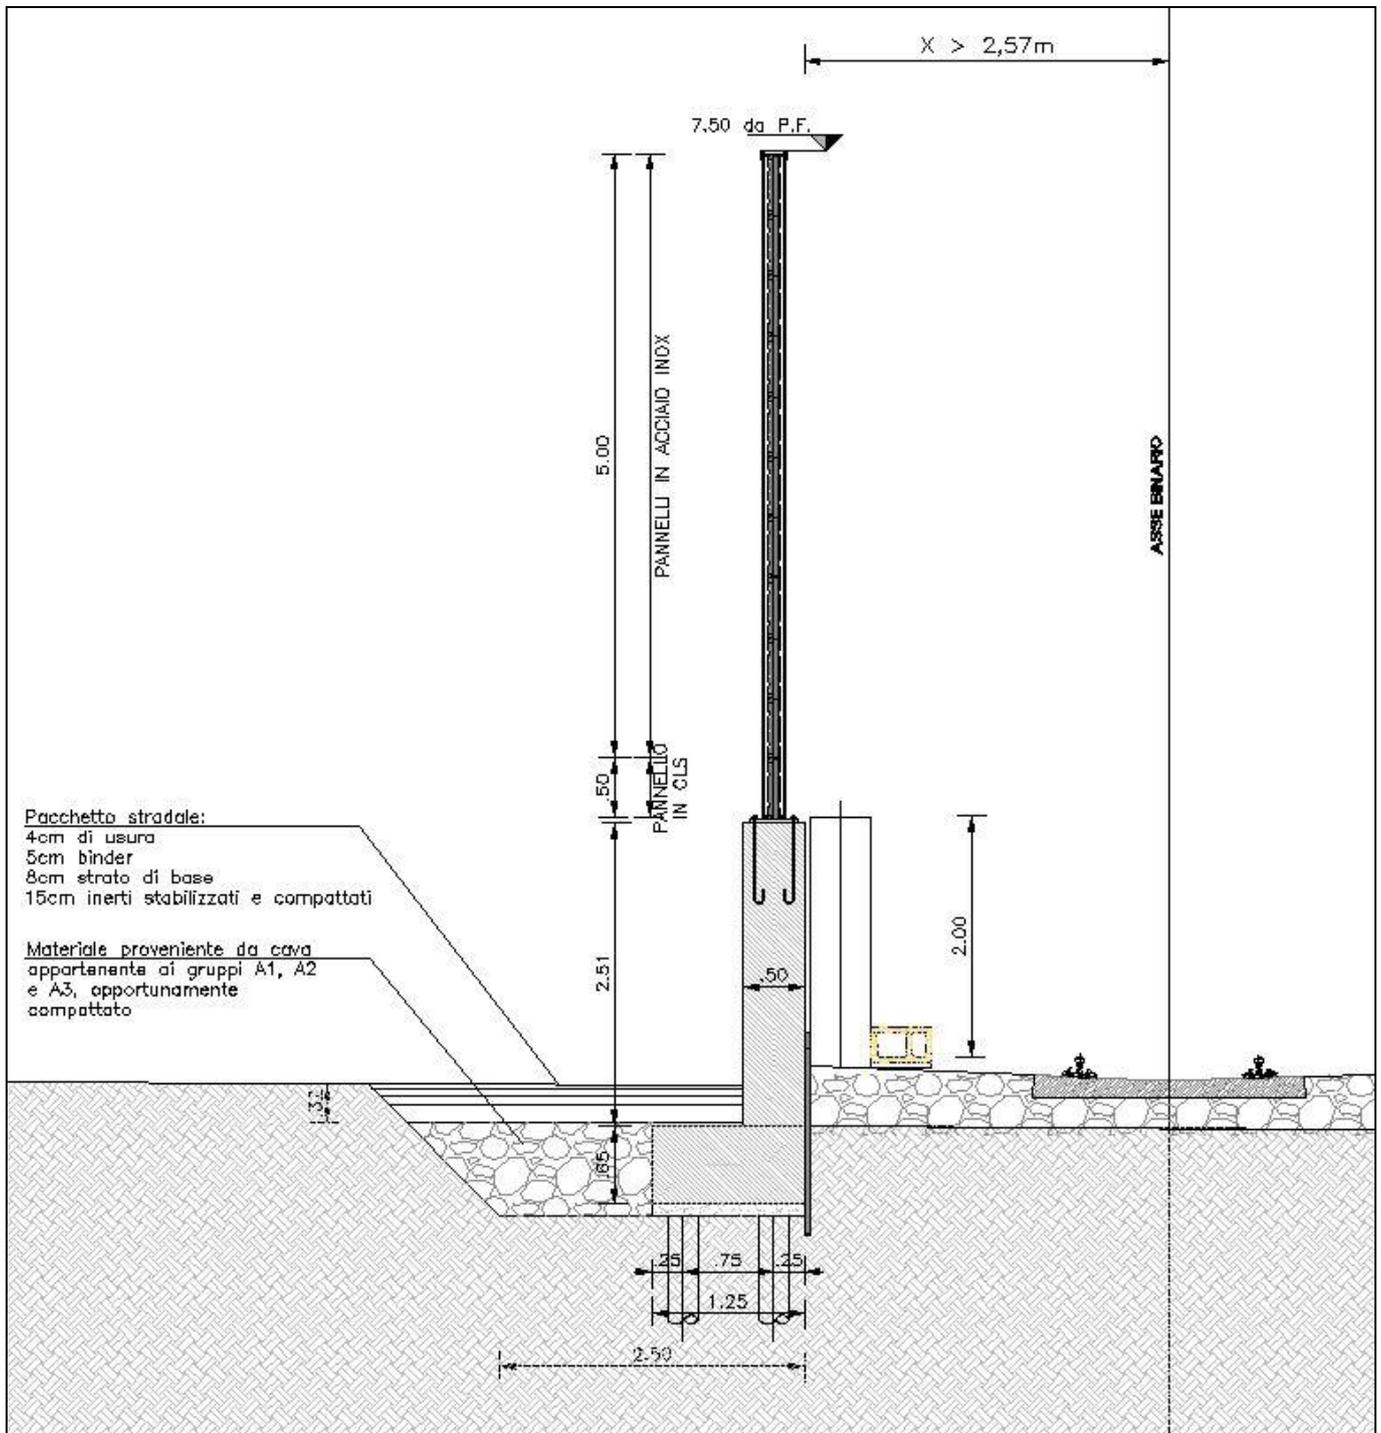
Sezione trasversale tipo con barriera metallica leggera H10
